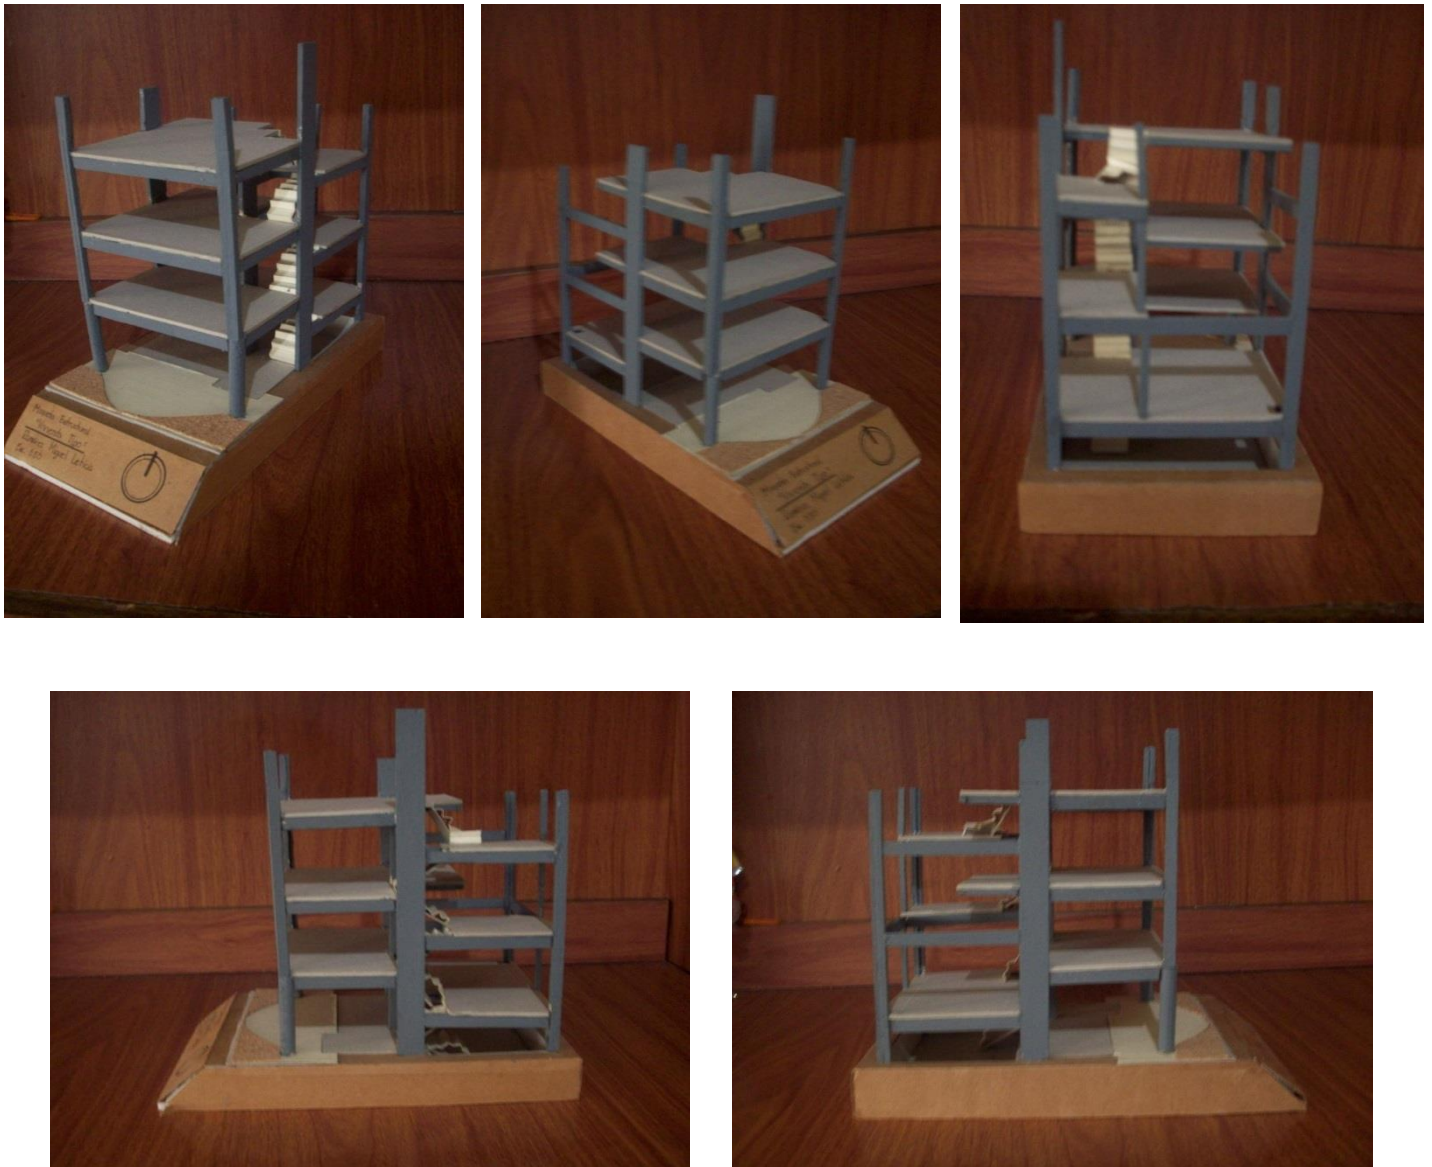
Fotografías de la maqueta de la estructura, donde se muestra la forma y unión de losas con el muro columna que rige al proyecto, así como sus apoyos y las columnas que crean el portal comercial y el arranque de las escaleras.
